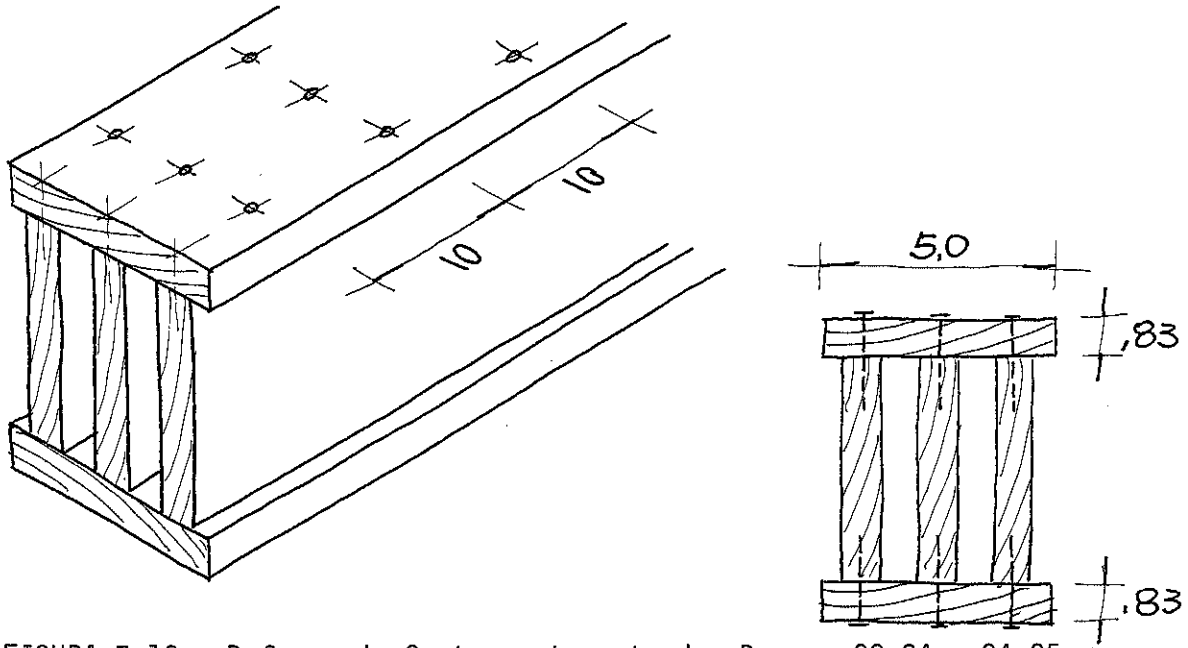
Reforço de Contraventamento das Barras 22-24 e 24-25
